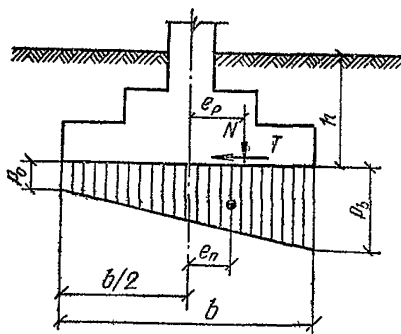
Эпюра предельного давления под подошвой фундамента при сейсмическом воздействии
